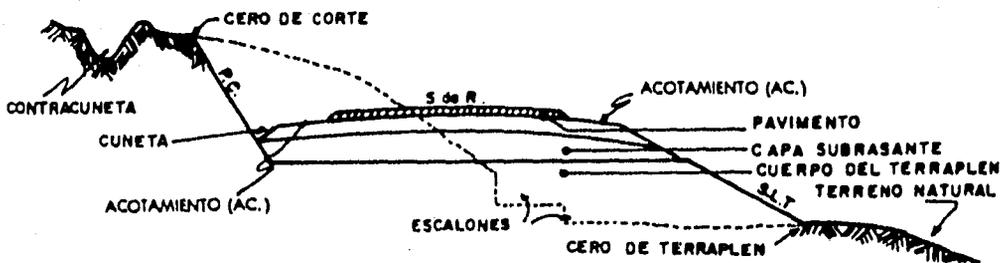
Sección transversal típica mixta o en balcón, para caminos de dos carriles.
